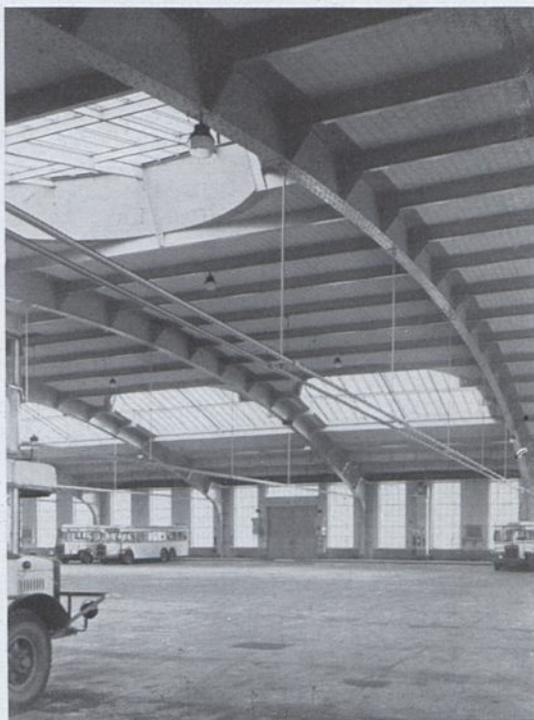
Halle III. Innenansicht mit Blick auf die südliche Längswand.
